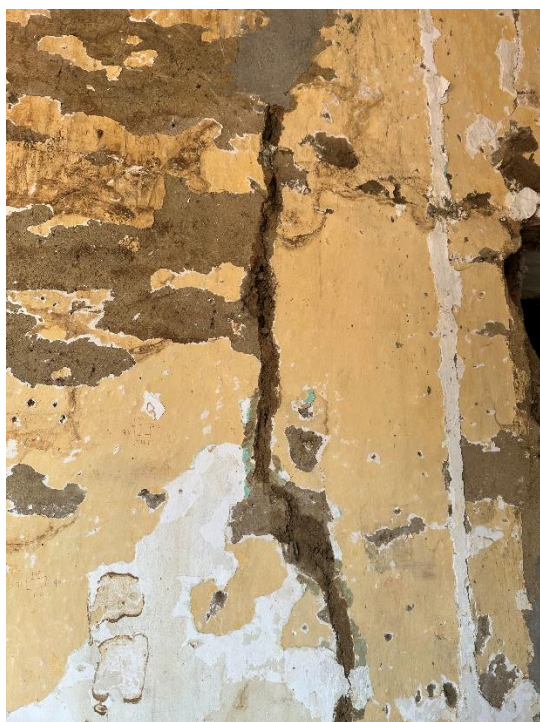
Fisuramientos de la mampostería en tapia pisada de las secretarías de despacho adyacentes al patio central
